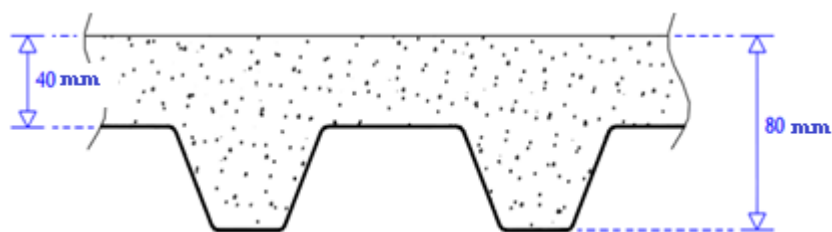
Espessuras mínimas [mm] da secção transversal de uma laje sem funções de contraventamento.
